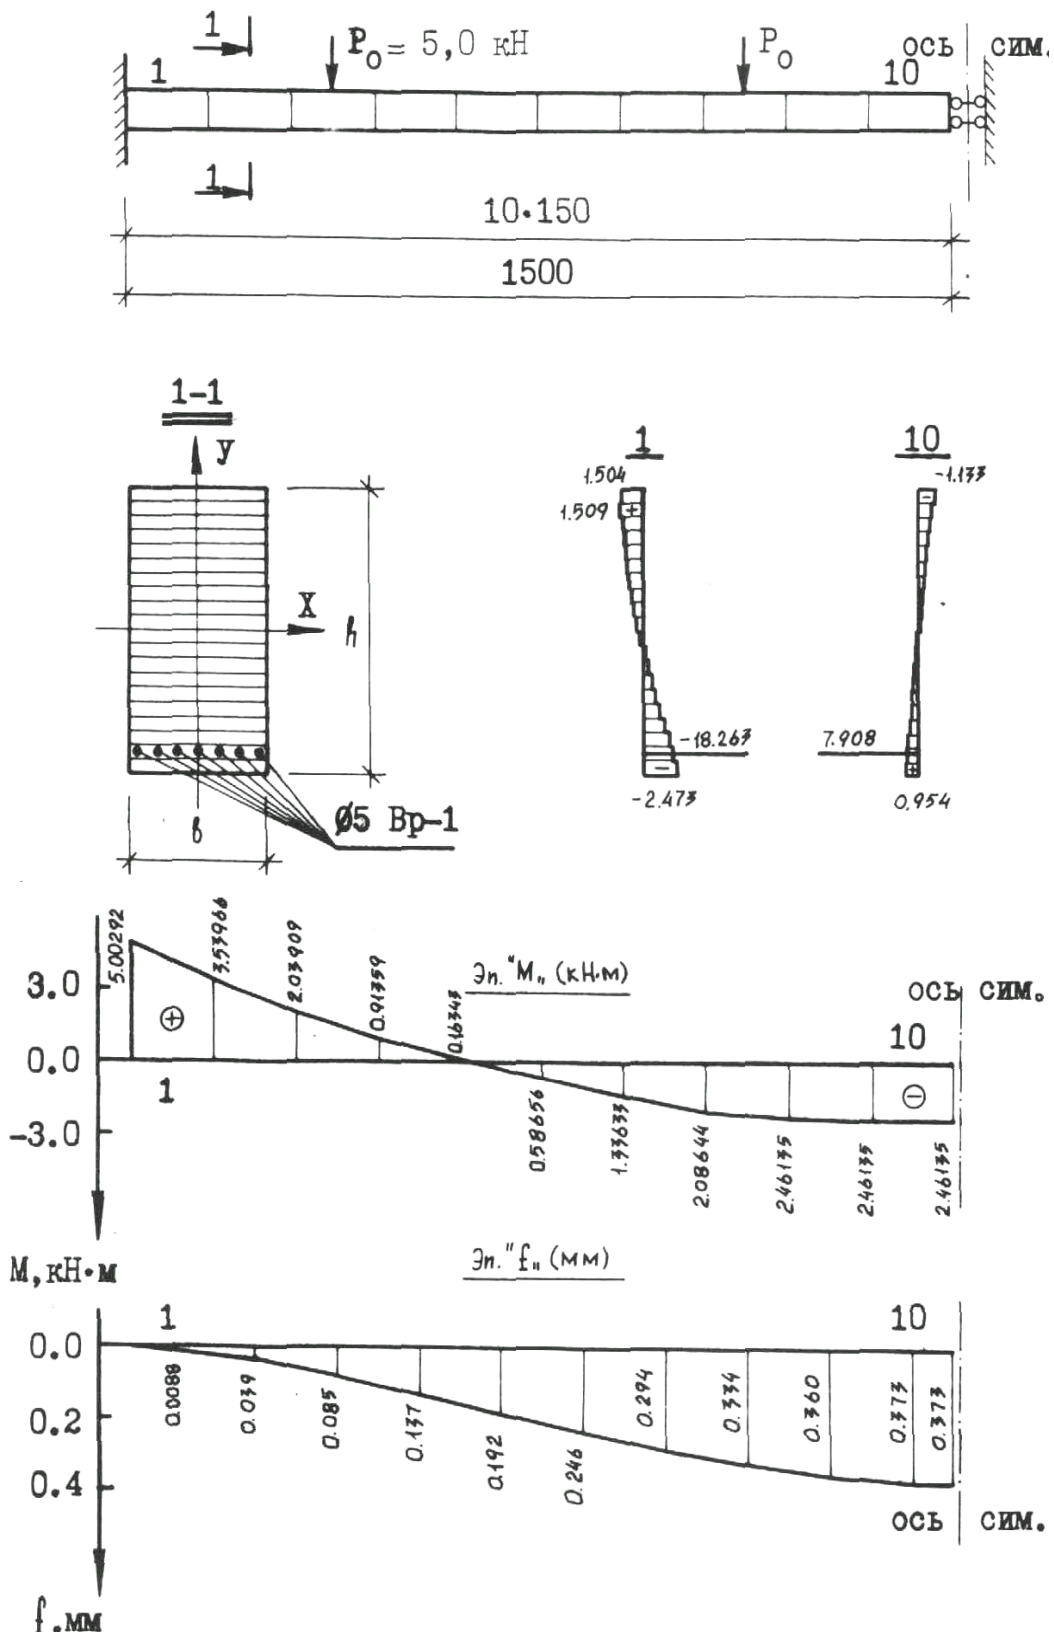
Эпюра напряженно-деформированное состояние сборных железобетонных плит перекрытий с использованием оси симметрии
